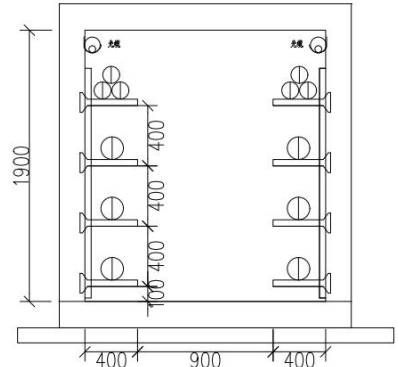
1.7*1.9m 电缆沟断面示意图
